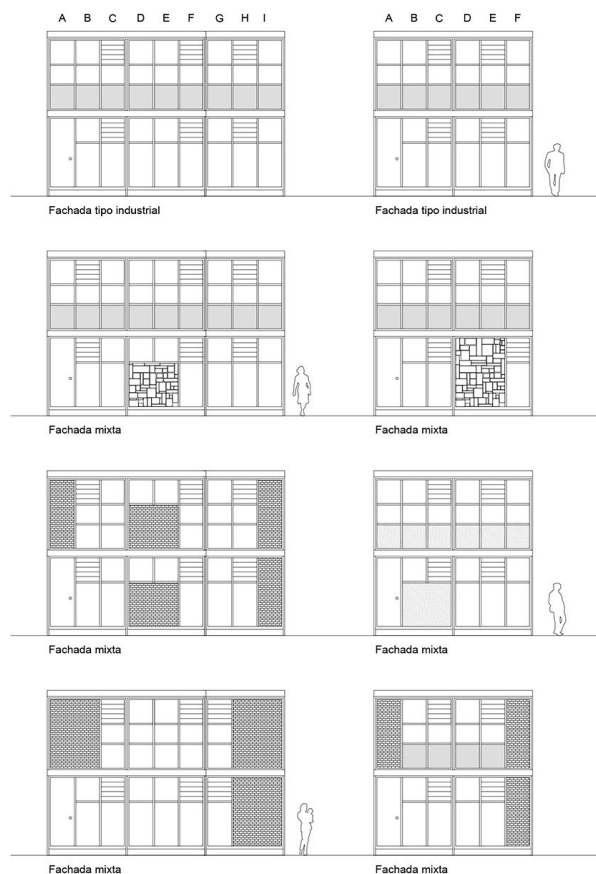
Extracto del catálogo constructivo de las fachadas. *Casas que crecen* de Pedro Ramírez Vázquez
